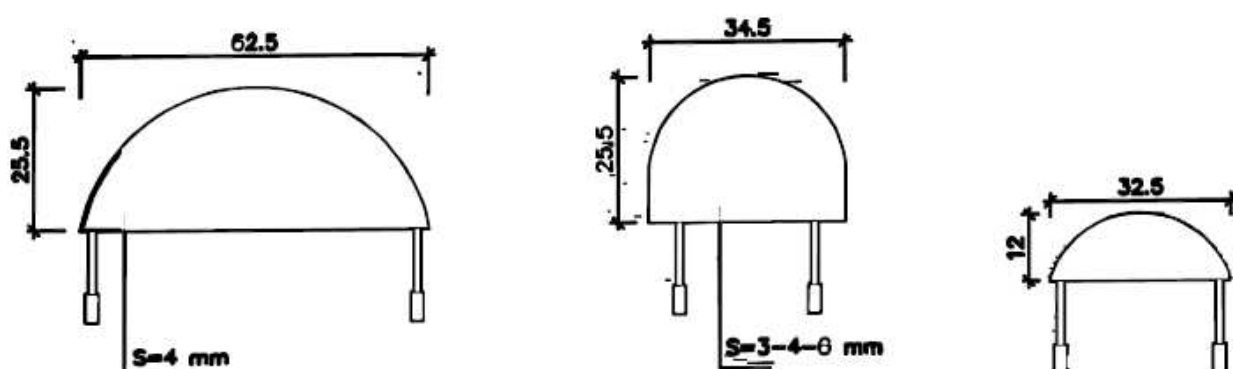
a - Forme e dimensioni di martinetti piatti per murature in pietrame
